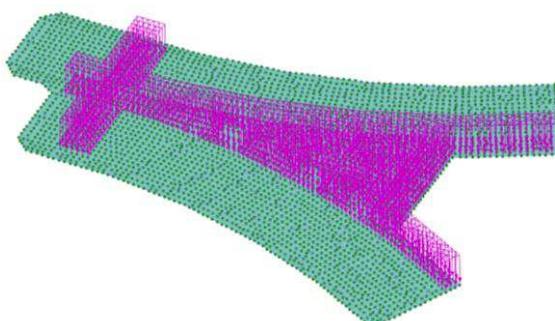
Нагрузка от людей в коридорах, возле жилых помещений, 2-27 этажи
